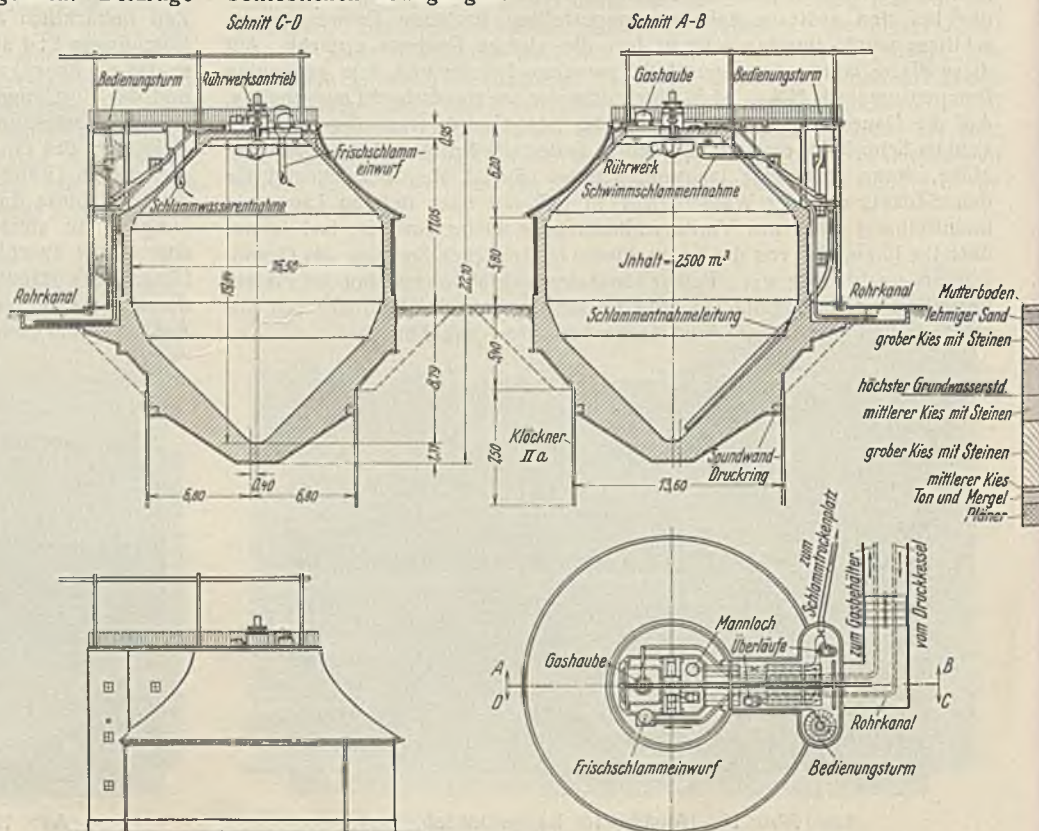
Eisenbeton-Schlammfaulbehälter von 2500 m³ Inhalt.
